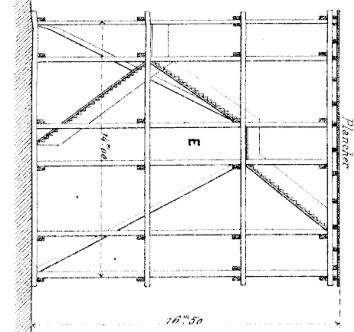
Vue latérale d'une moitié à 0m003 p.1m.
